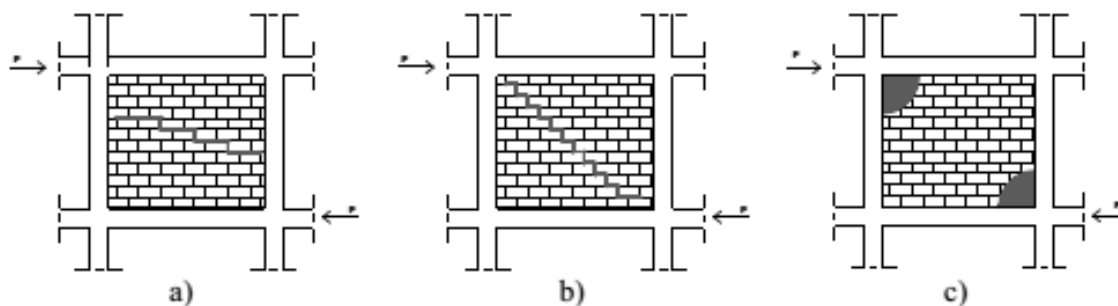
Mecanismos de rotura de painéis de alvenaria (a) Rotura ao longo das juntas (b) Fissuração diagonal (c) Rotura por esmagamento dos cantos.
